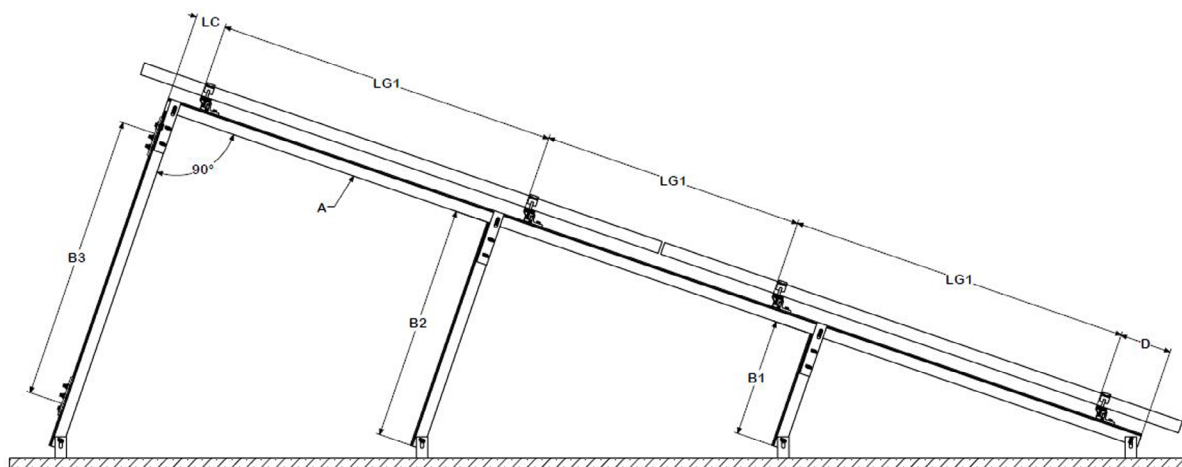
Dimensiones de ensamble para el sistema CrossRail Tilt Up Multi Row 1 Fila.
